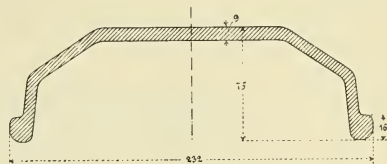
Querschnitt einer flußeisernen Querschwelle.
